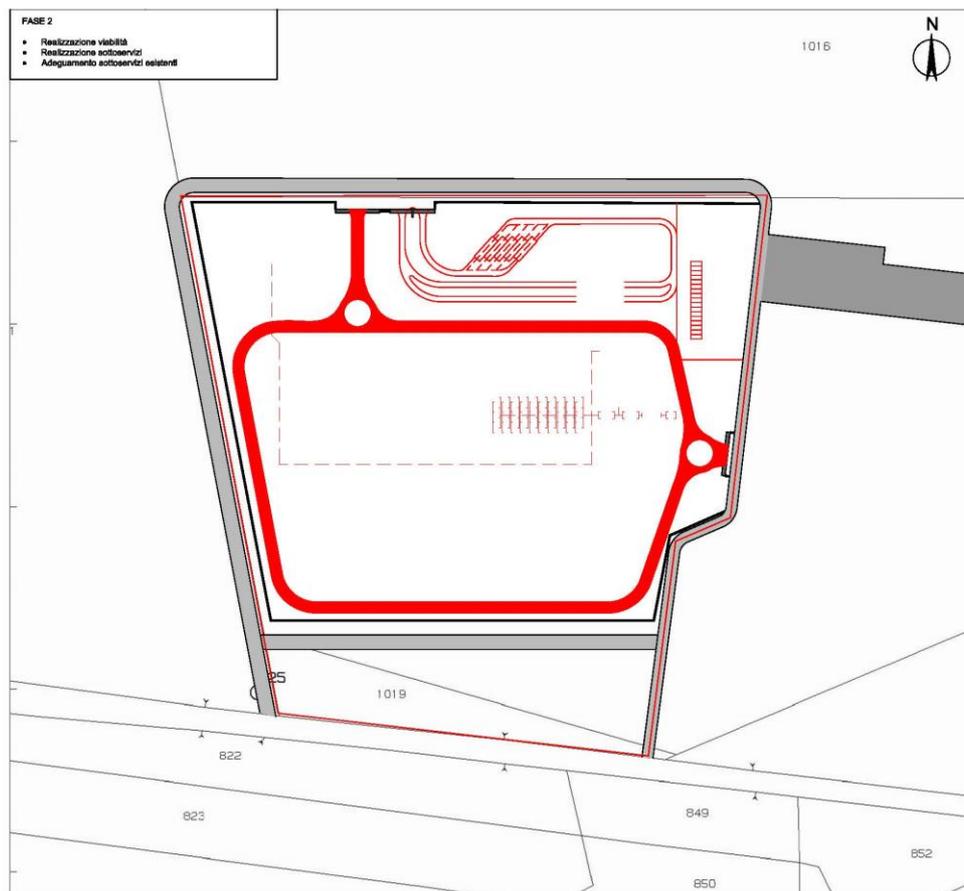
Fase 2. Area oggetto delle lavorazioni previste.
